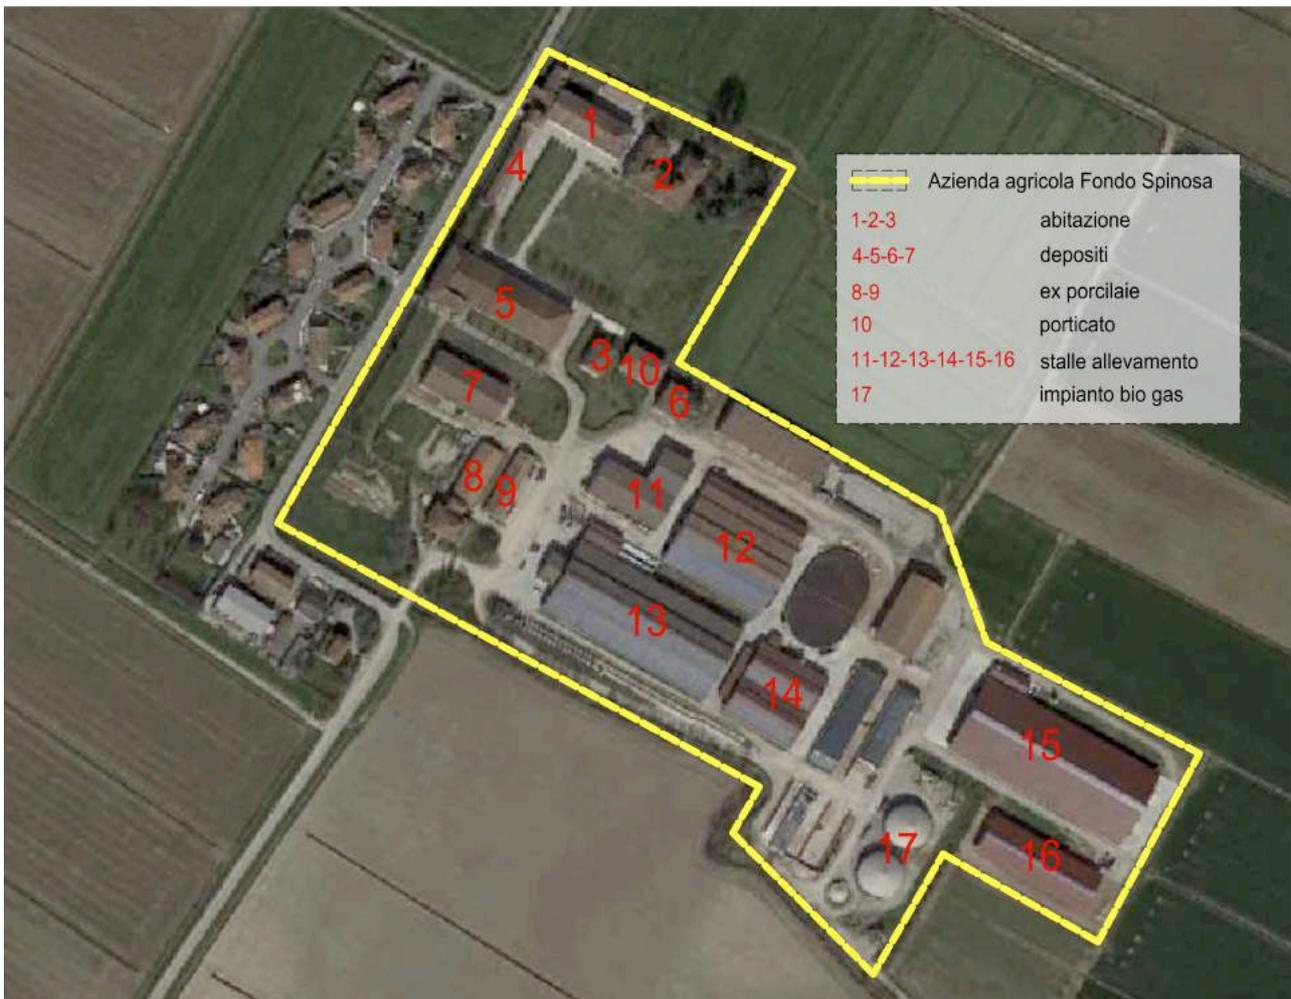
Foto aerea – planimetria generale Azienda Agricola Fondo Spinosa
